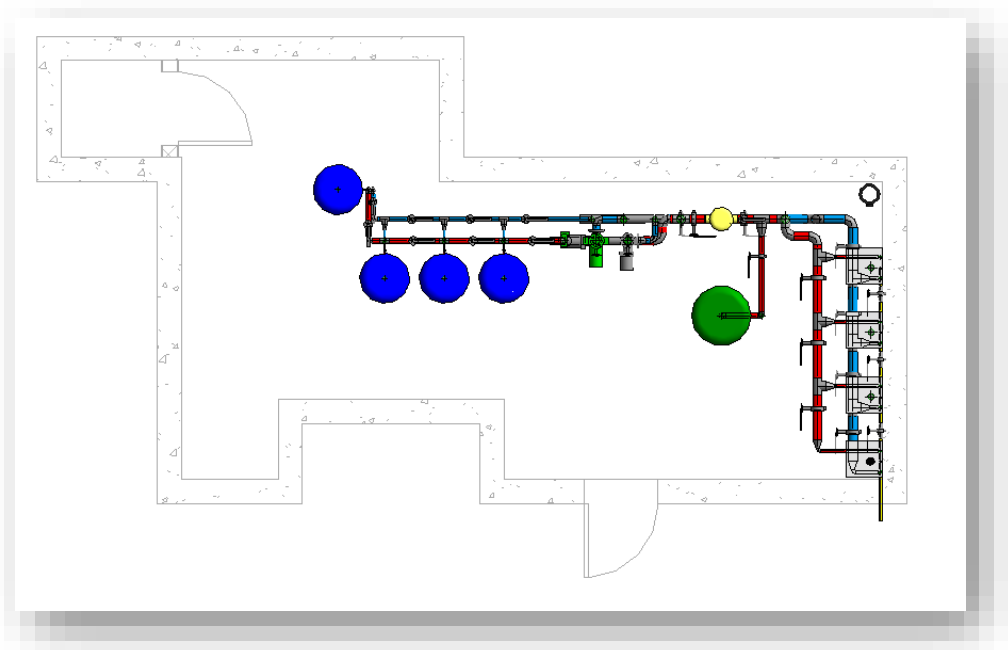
Planta sala de calderas de edificio de viviendas en Valladolid
